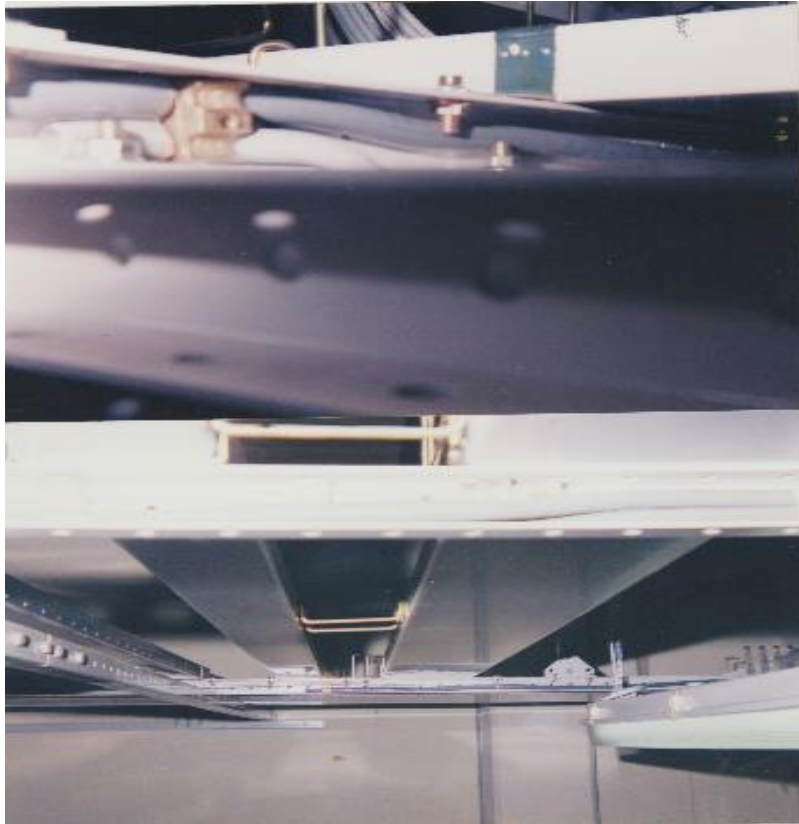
Tendido de cableado de tierra por parte del proveedor del equipo.
